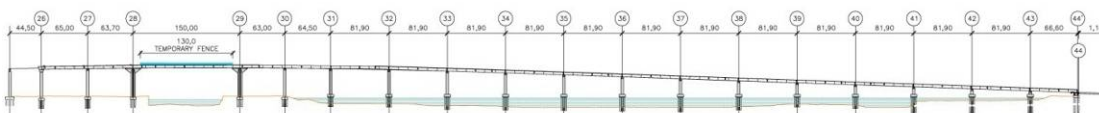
Vista general del tramo empujado. Alzado longitudinal
